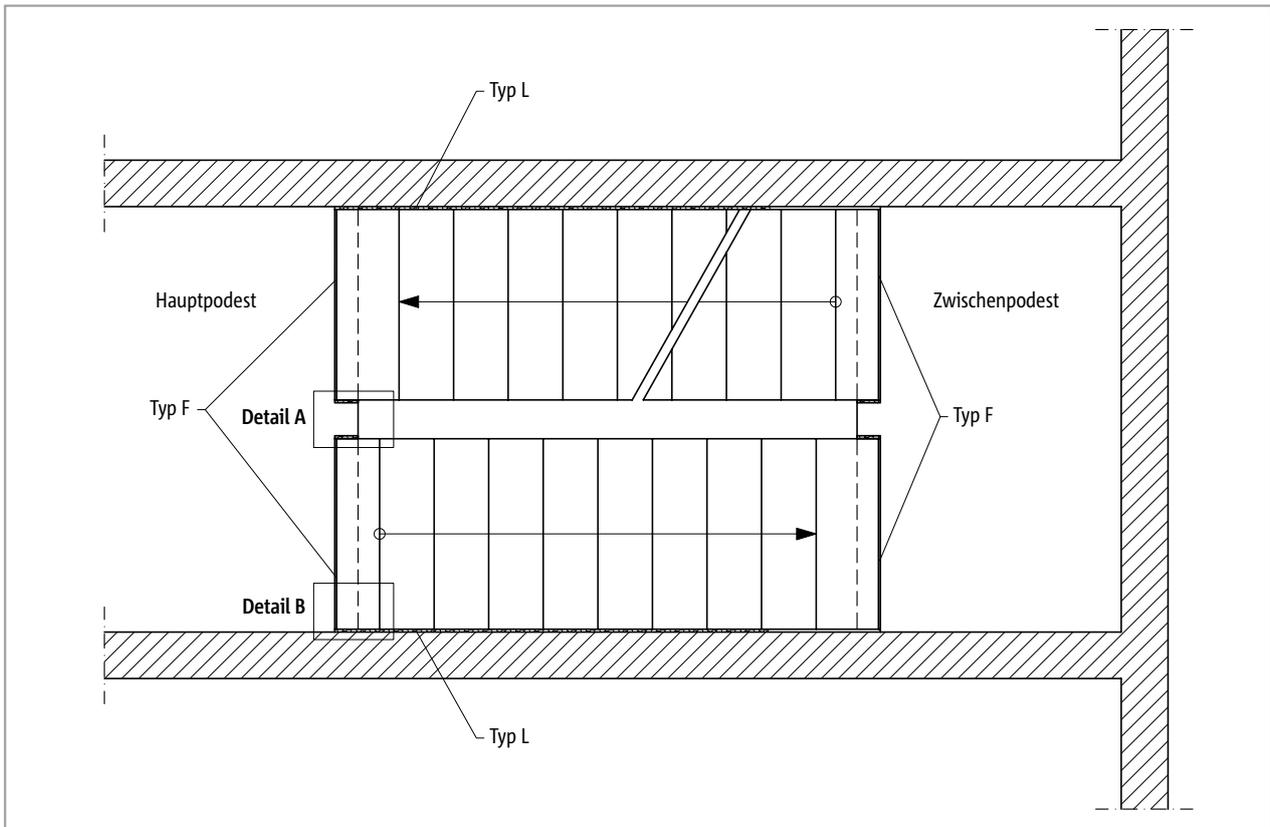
Schöck Tronsole® Typ F: Elementanordnung im Grundriss
